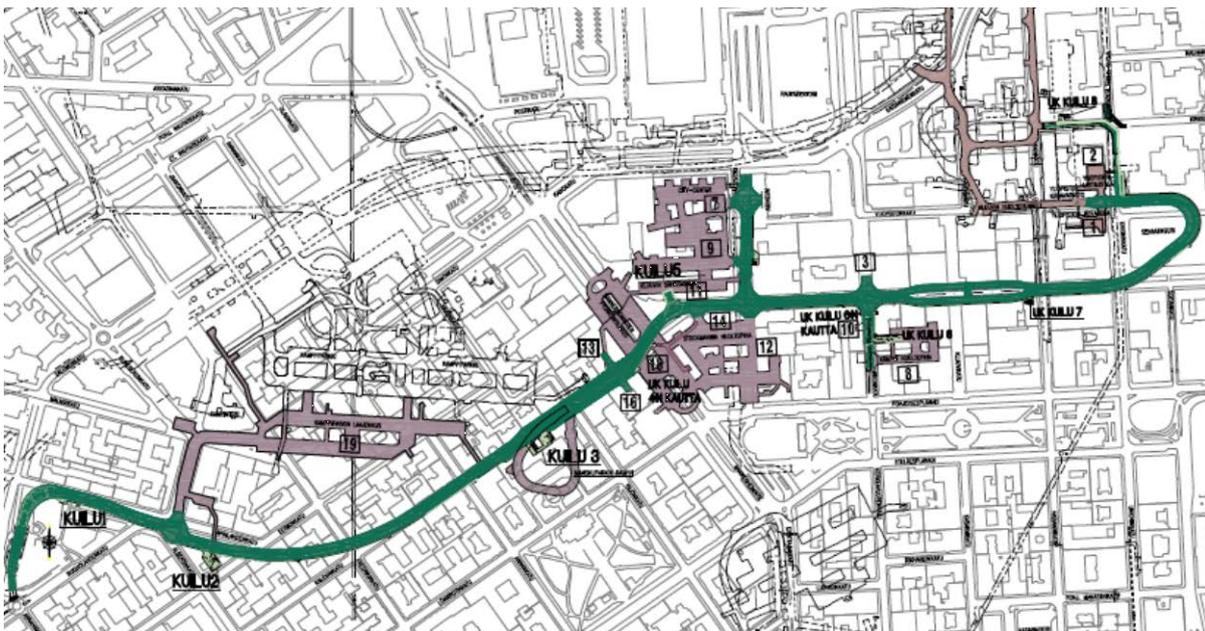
plan de situation du tunnel de service du centre-ville d'Helsinki
